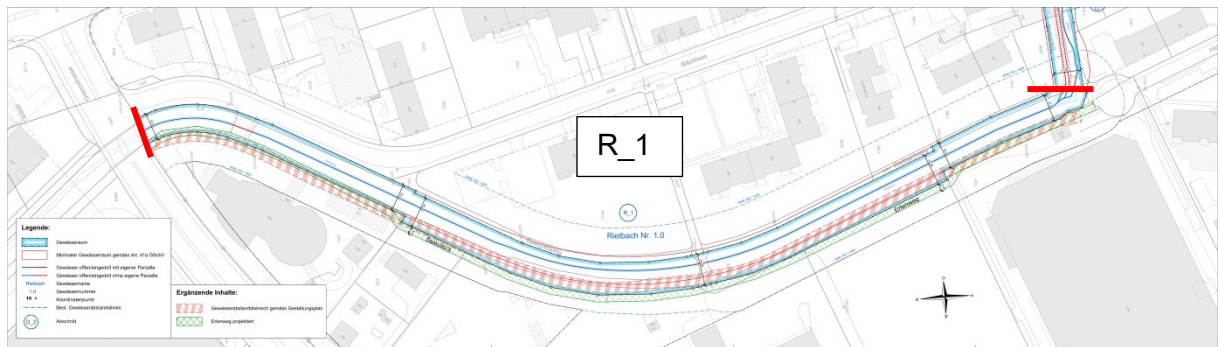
Plan 38630 – 01 mit dem Abschnitt R_1 des Rietbachs Nr. 1.0.
